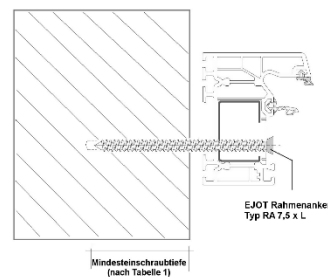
Montageausführung: seitlicher Anschluss für Kunststofffenster mit Stahlarmierung (1 Wandung) in druckfestem Mauerwerk
